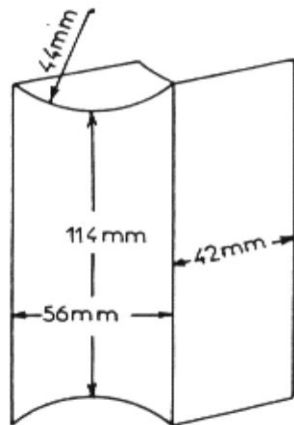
Epreuve et la fissuration dans l'essai de cission [2]
